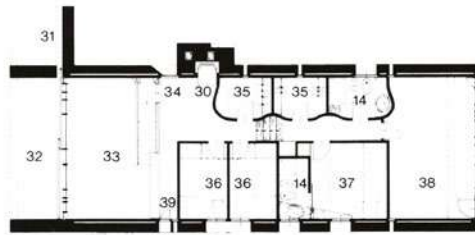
G. Gresleri, Casa Edda, planimetria del lotto
